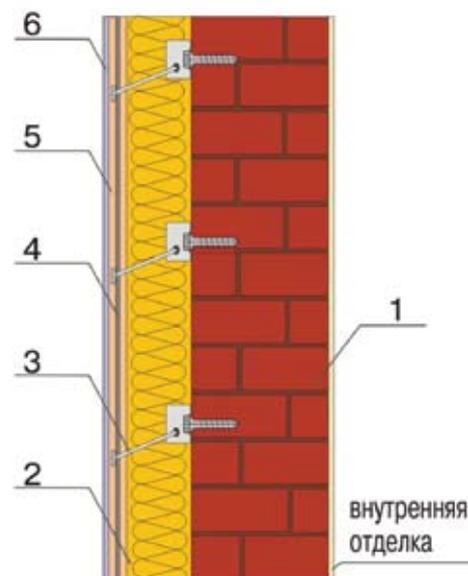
Утепление стены плитами ИЗОФАС в конструкции с толстослойным штукатурным покрытием: 1. Несущая стена; 2. Плиты ИЗОФАС-90, ИЗОФАС-110; 3. Подвижный элемент крепления; 4. Армирующая сварная оцинкованная сетка; 5. Штукатурный слой (20-25 мм); 6. Окраска декоративная
